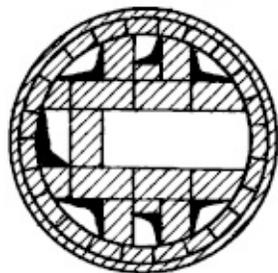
(продолжение). Кладка отопительной круглой печи в металлическом футляре
